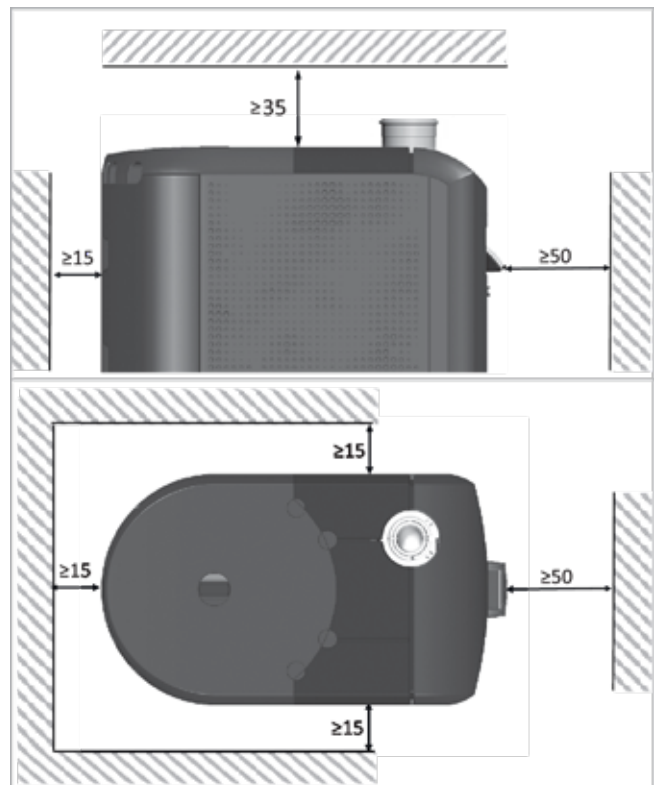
Mindestabstände SolvisBen (alle Maße in cm)
